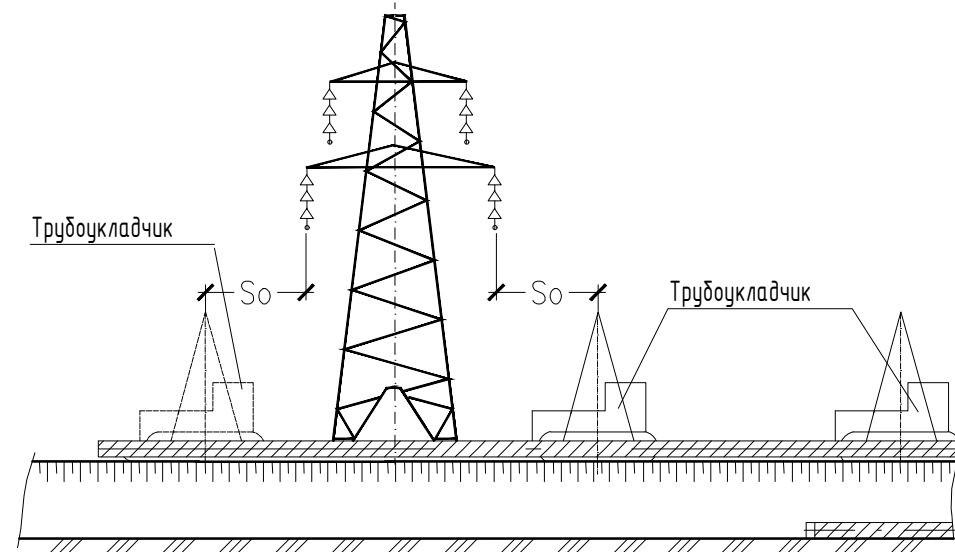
Схема укладки изолированного трубопровода непрерывным способом
